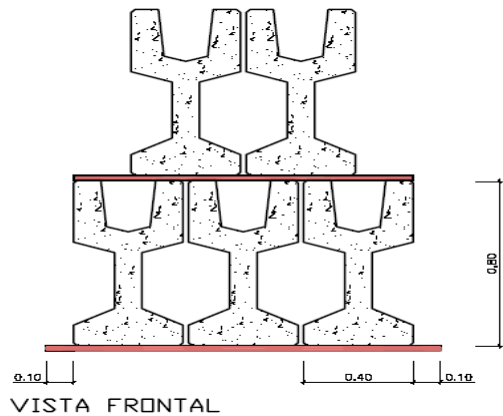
Esquema de armazenamento de Viga I Calha Protendida sobre madeira (fonte: Incospal, 2006-b).
